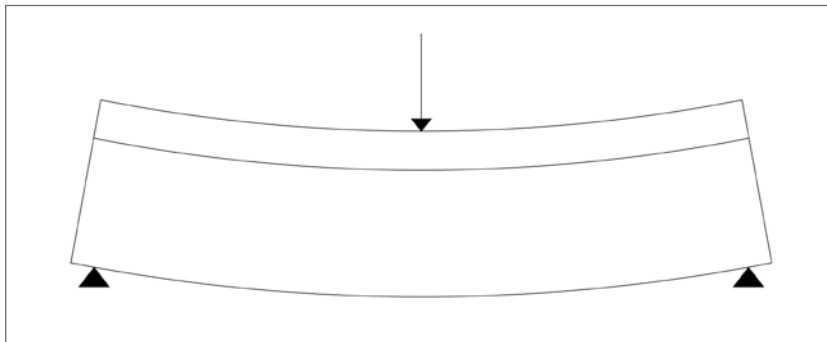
Déformée sous charge ponctuelle d'une poutre mixte avec connexion infiniment rigide
